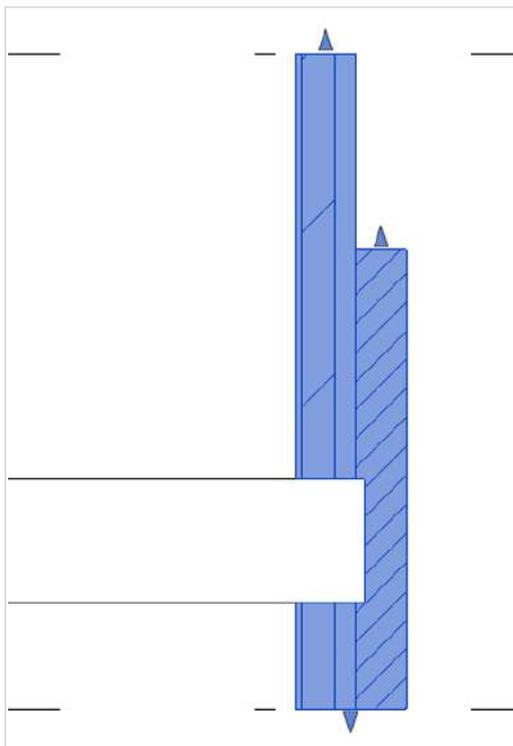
Muro modelado en Revit con capas. Elaboración propia.
